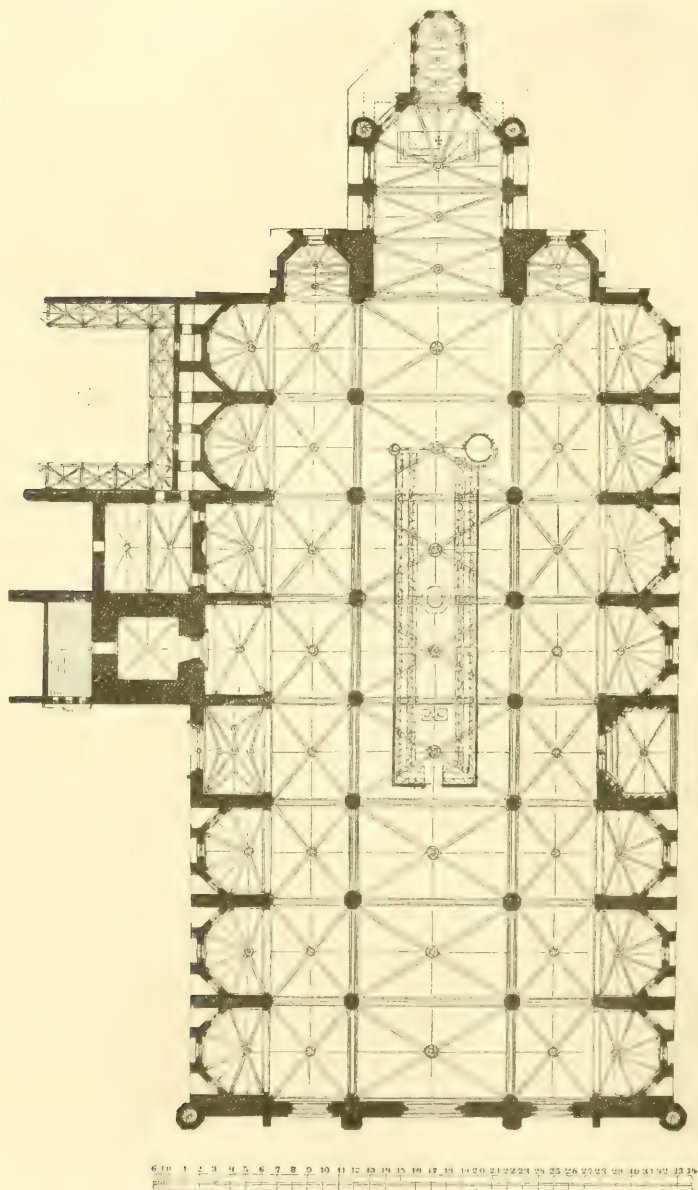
Grundriss von der Kathedrale zu Palma. (Schulz-Ferenz.)
